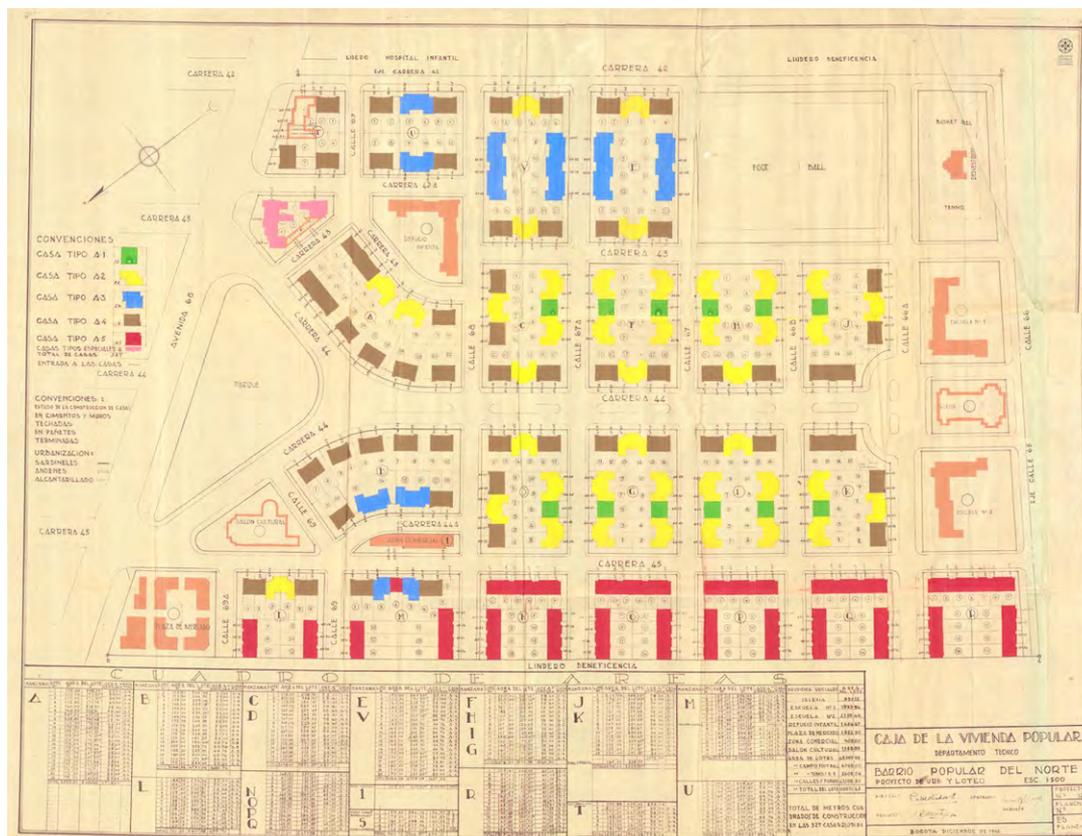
Plano general del barrio Popular Modelo del Norte 1942. Archivo General de la Nación.
